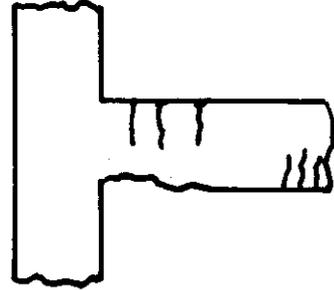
b. Daños en vigas por grietas verticales y aplastamiento del concreto
